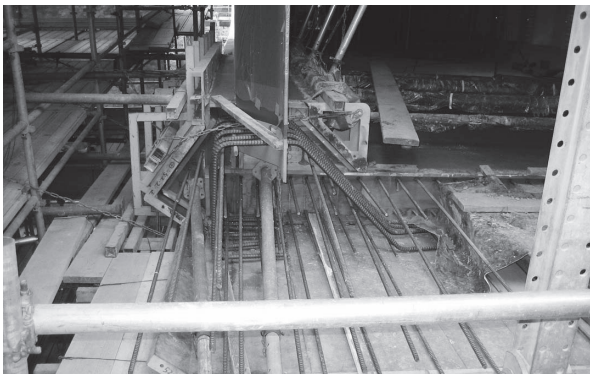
波形鋼板ウェブ施工状況 (埋込み接合)
